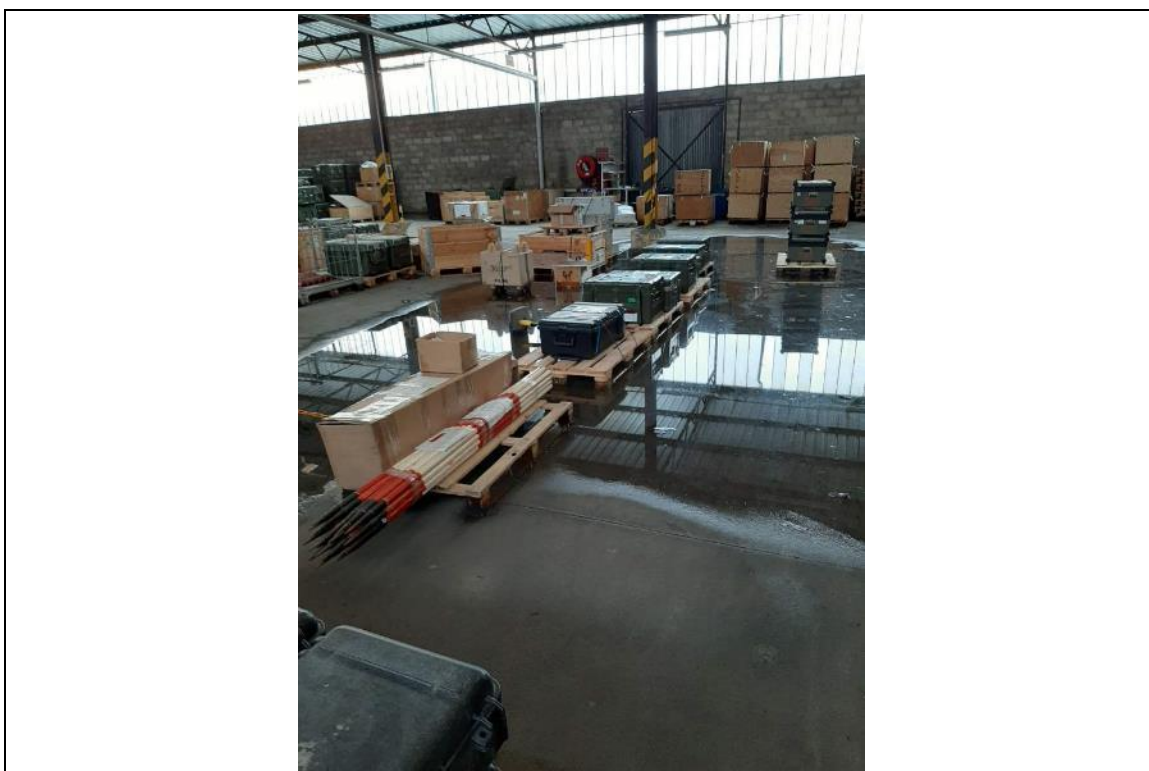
Défaits d'étanchéité - Répartis sur l'ensemble de la couverture
